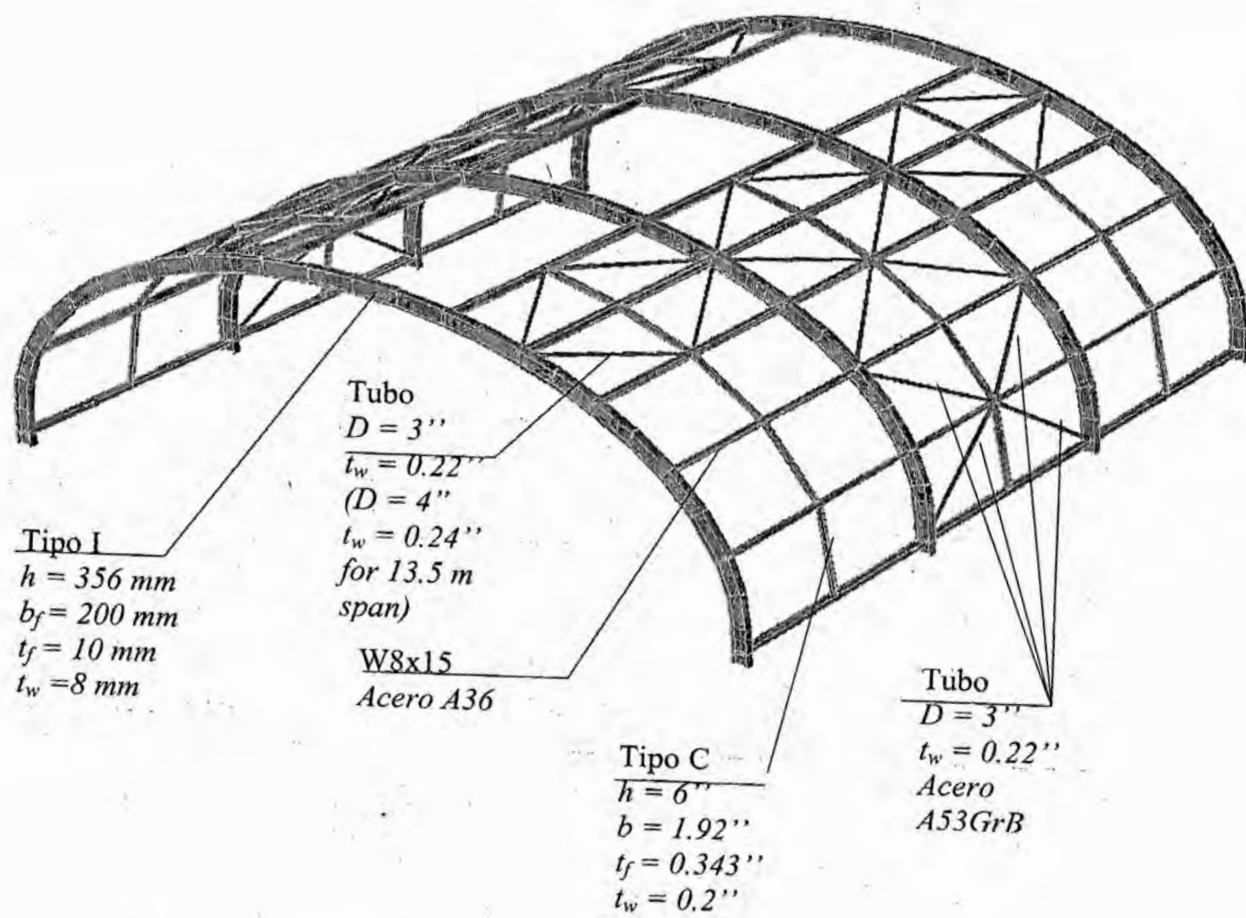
Sección de acero de estructura metálica (Fuente: SAP 2000)
